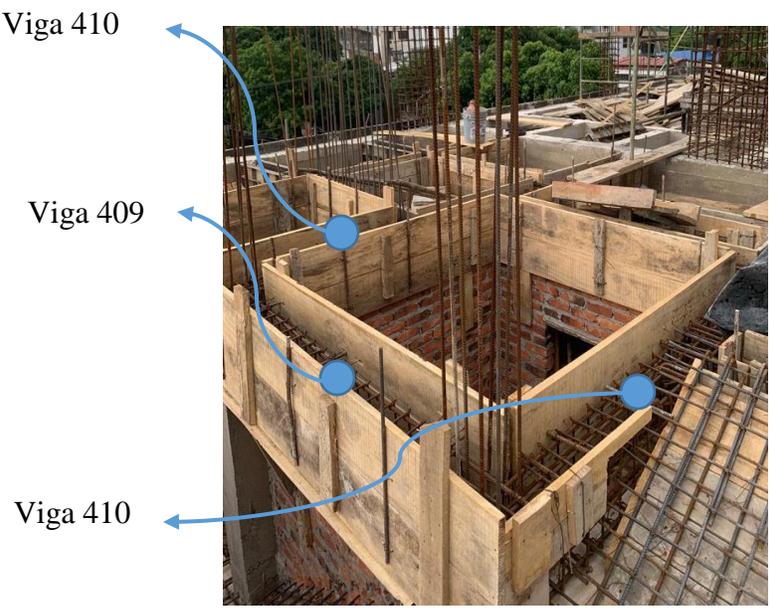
Encofrado de vigas ascensor Edificio Wiedii
